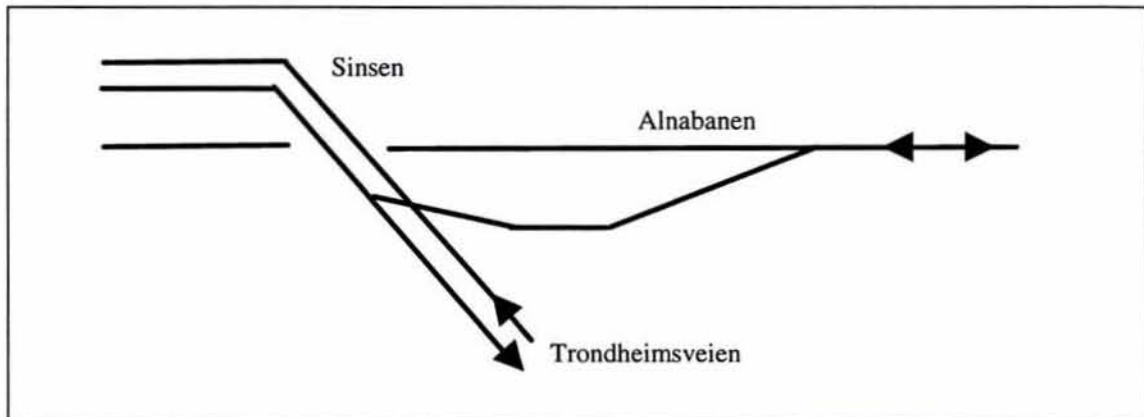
Planskilt kopling mellom Alnabanen og T-baneringen.
